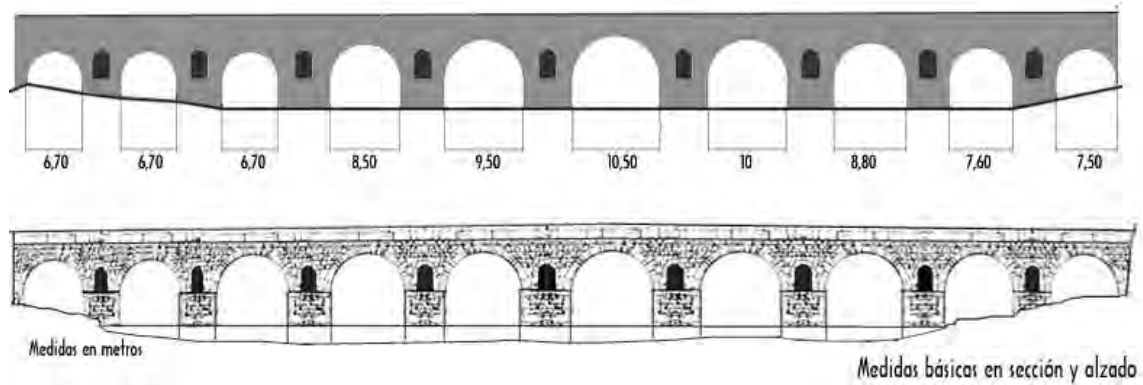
Alzado del primer tramo del Puente sobre el Guadiana
